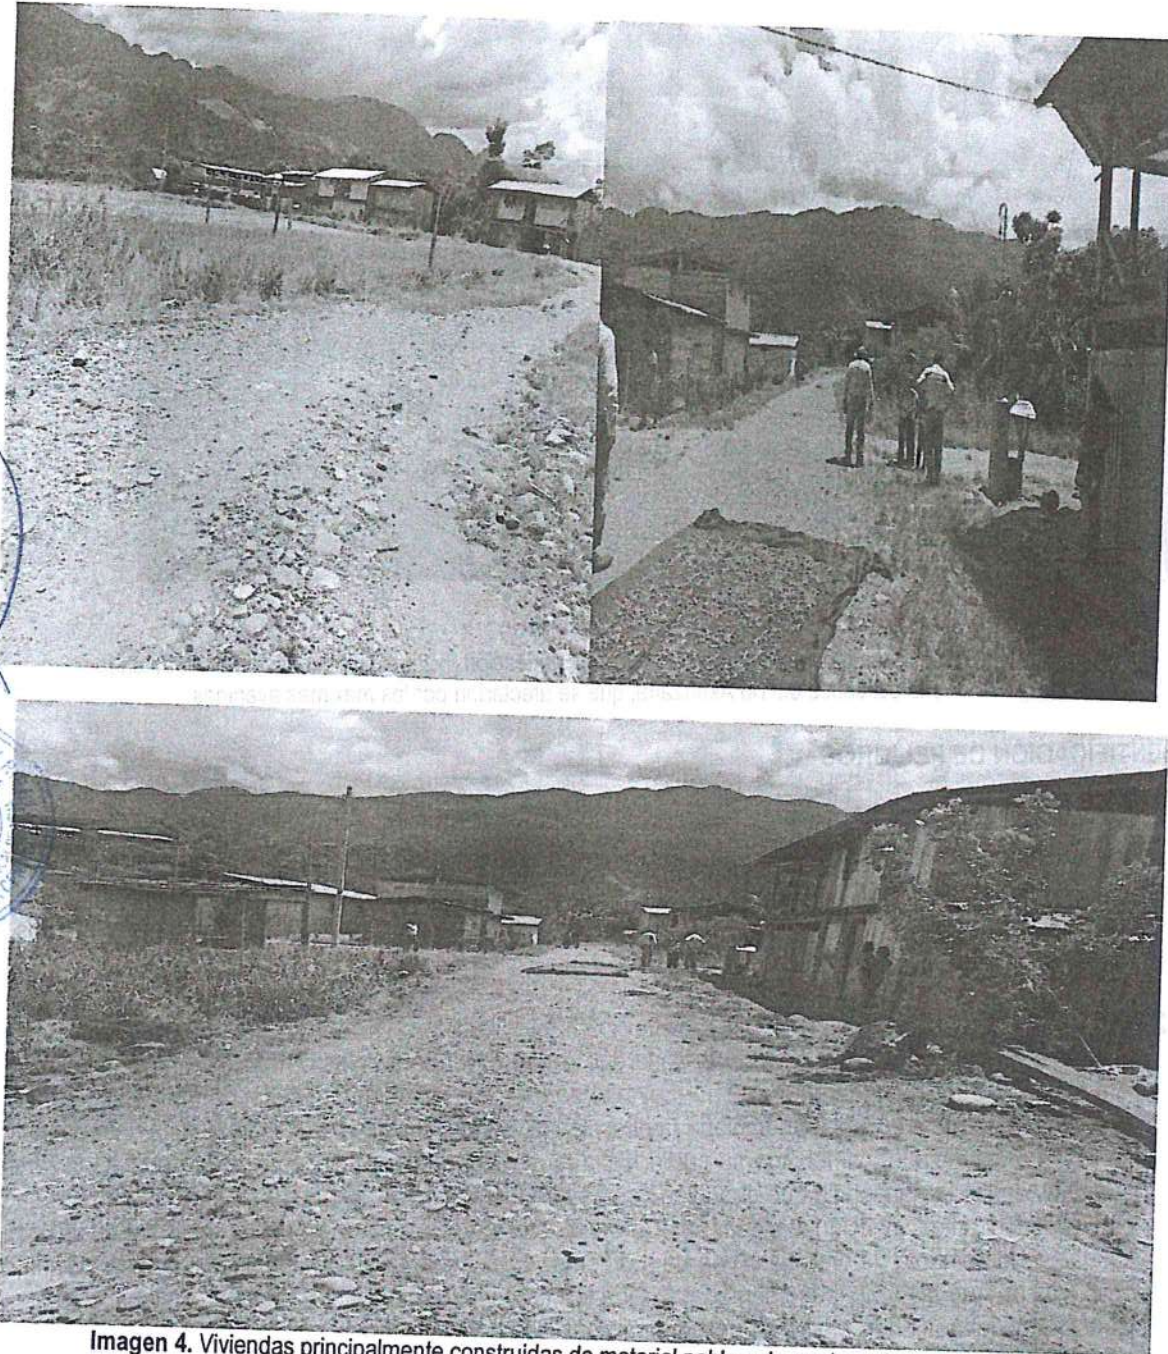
Viviendas principalmente construidas de material noble y de madera sin un adecuado criterio técnico constructivo
